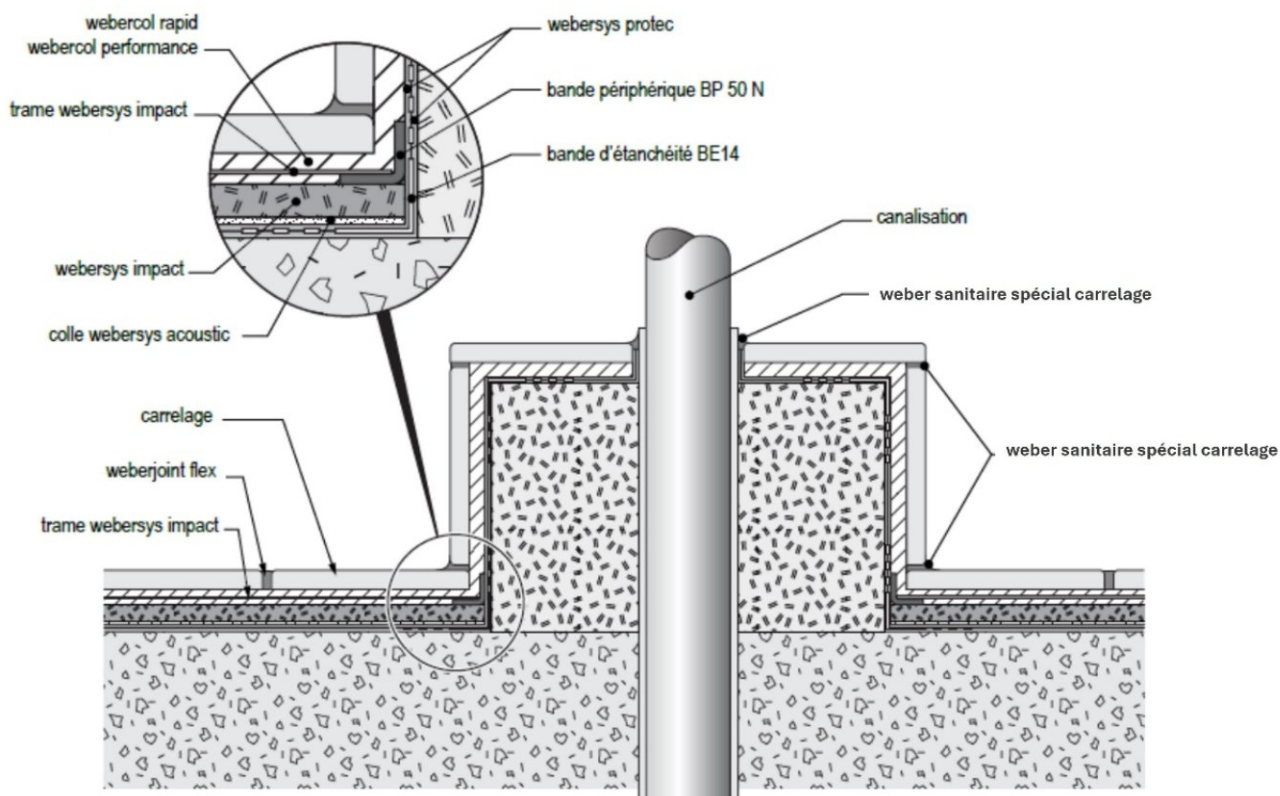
Traitement d'une canalisation traversante en sol sur supports sensibles
